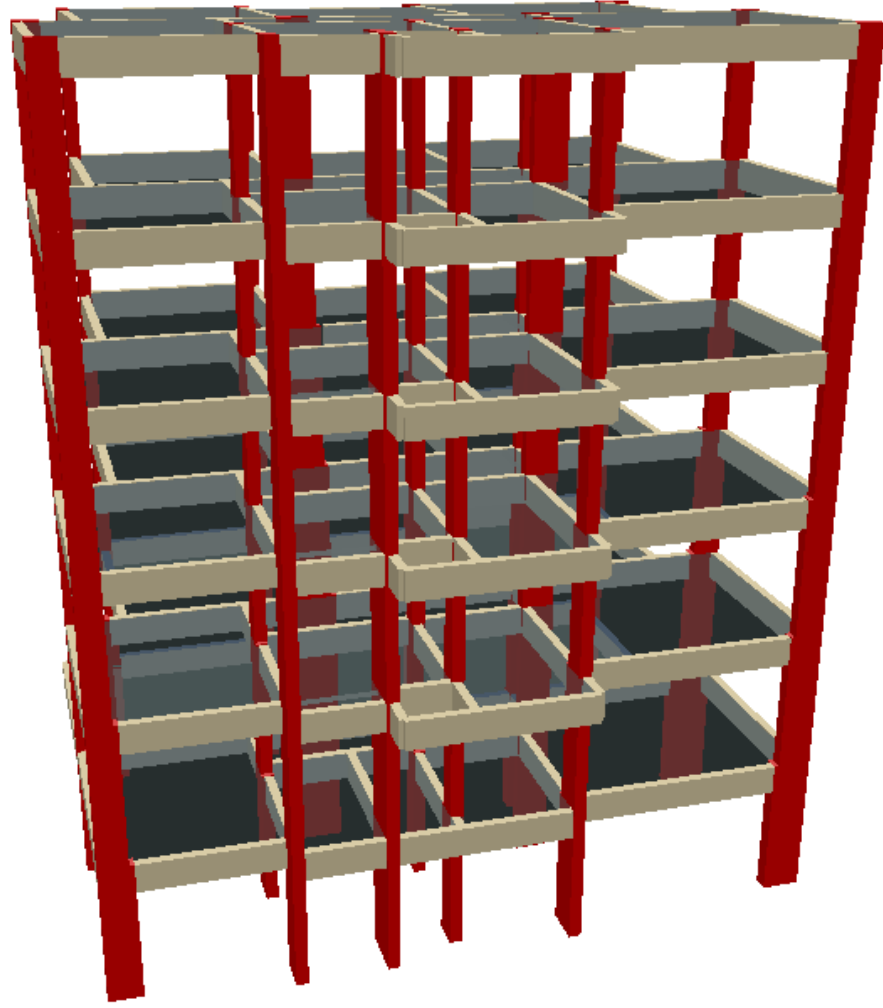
Örnek 5 katlı binaya ait kalıp planı
